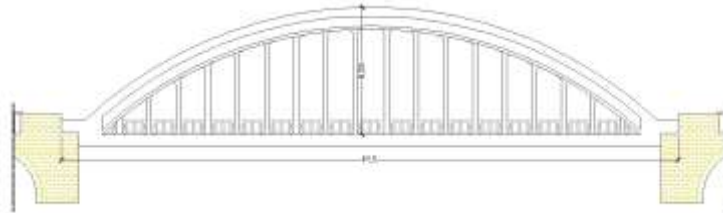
Prospetto ponte sulla SP 58 - Casteltermini
